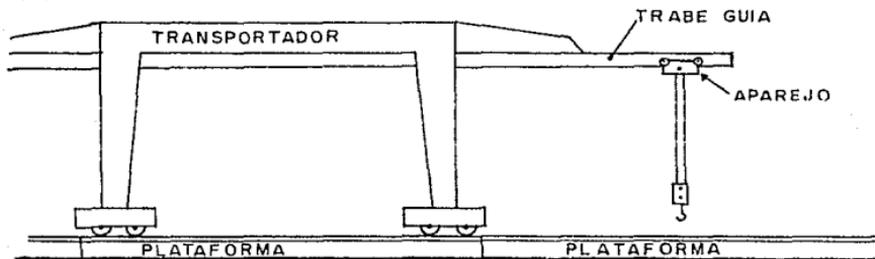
Trave guía y aparejo eléctrico del transportador.
